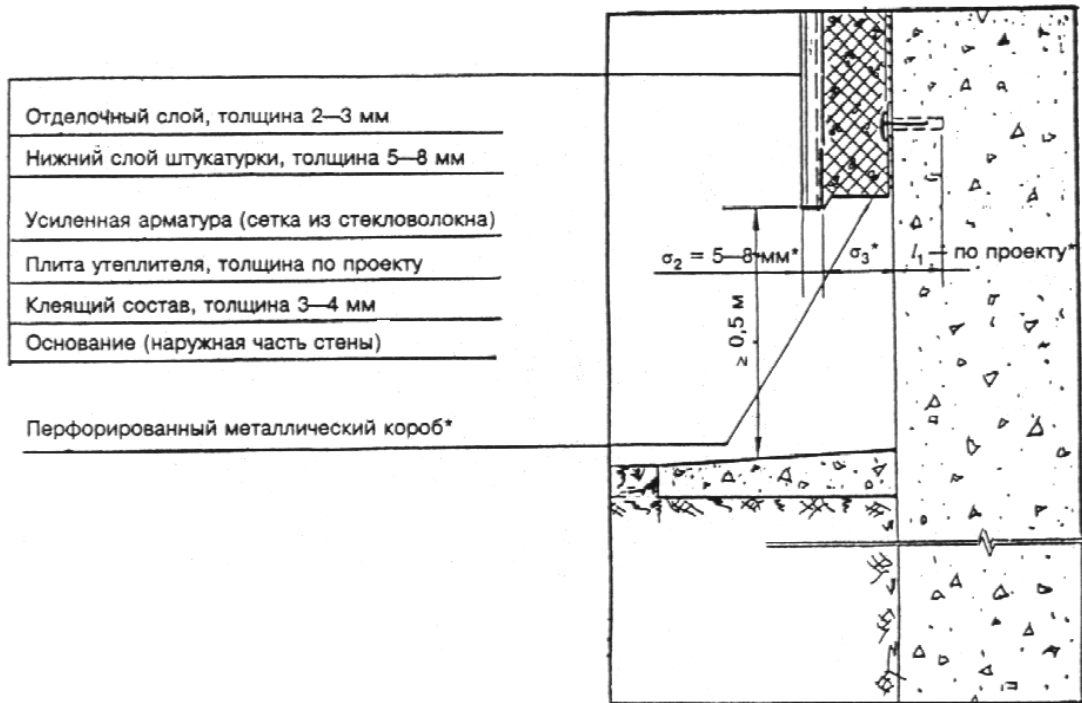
Крепление теплоизоляционного слоя на нижней части стены
